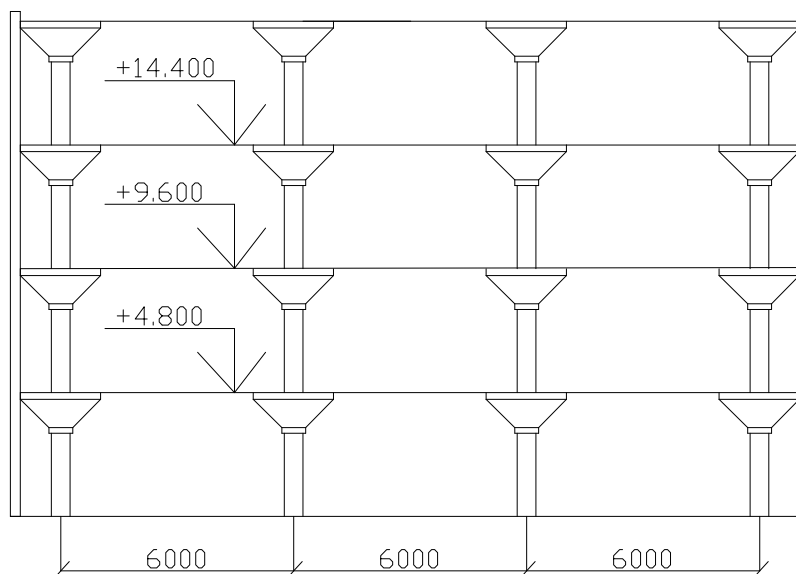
Конструкции зданий многоэтажных промышленных зданий с безбалочными перекрытиями
